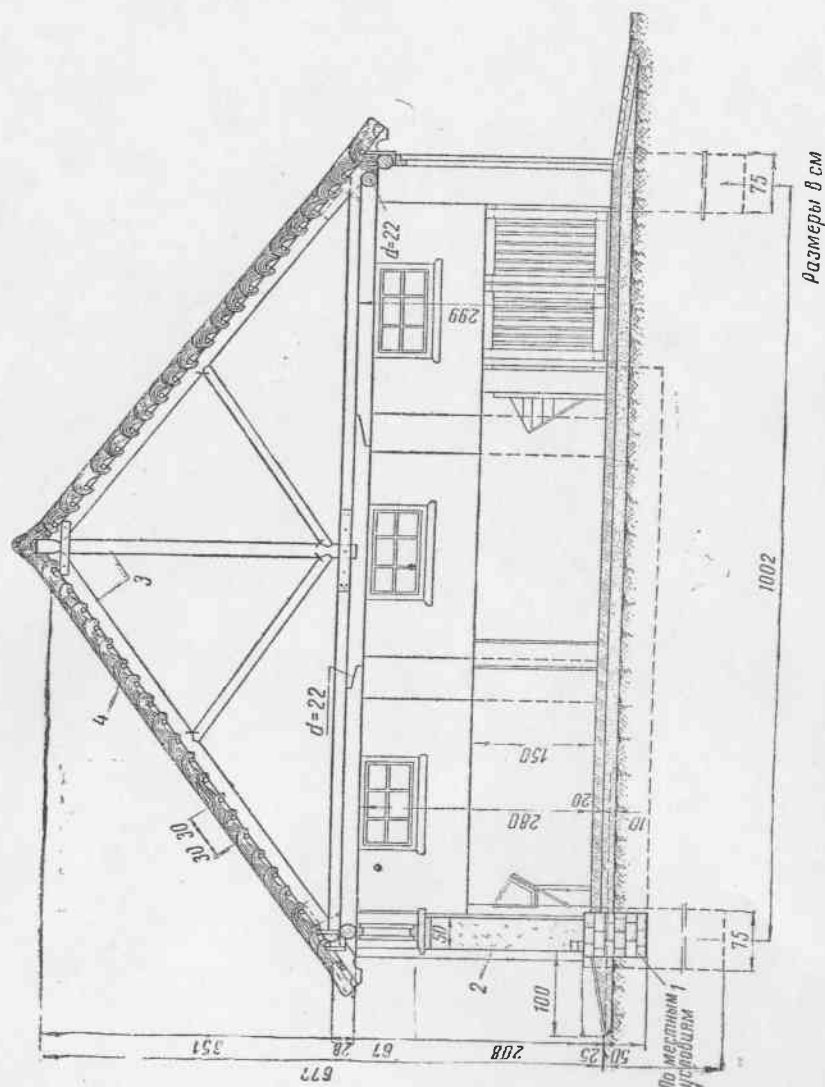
Поперечный разрез конюшни на 100 племенных жеребят (вариант без потолочного перекрытия): 1—бутовая заборка; 2—саманная стена; 3—висячая стропильная ферма; 4—кровля глиносоломная или камышовая.
